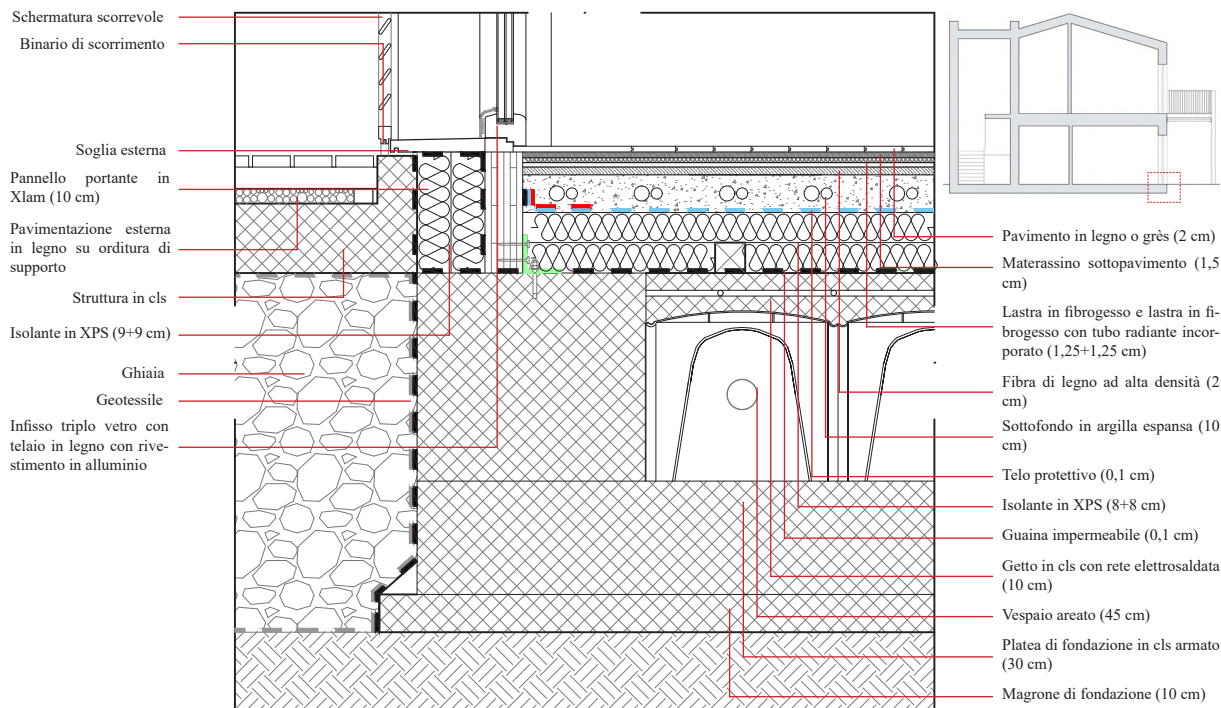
Nodo solaio a terra - parete perimetrale con pavimentazione esterna in legno (scala 1:20)
